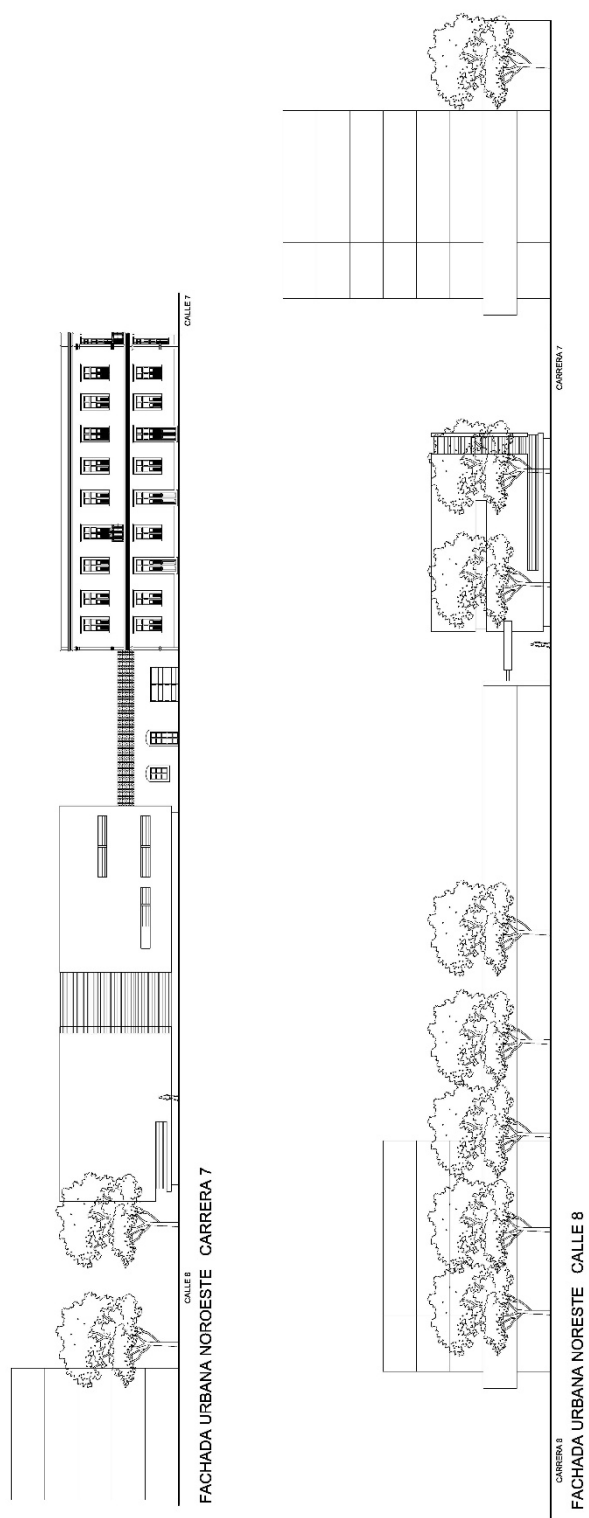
Plano arquitectónico Fachadas . Fuente: Elaboración Propia
